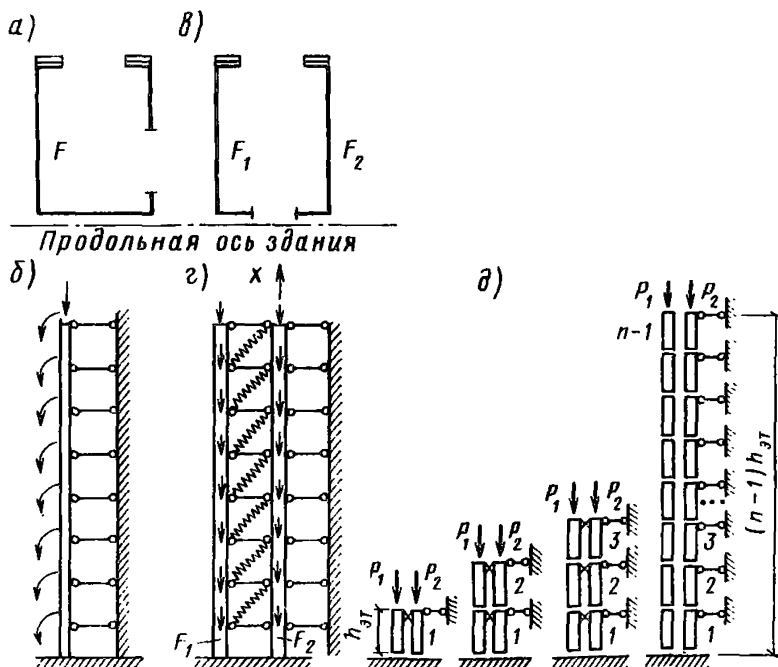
Схема расчета столба на изгиб в направлении продольной оси здания. Блок с проемом в одной торцовой стене (а) и его расчетная схема (б); с проемами в обеих торцовых стенах (в) и расчетная схема столба в целом (г); расчетная схема в процессе монтажа (д)
